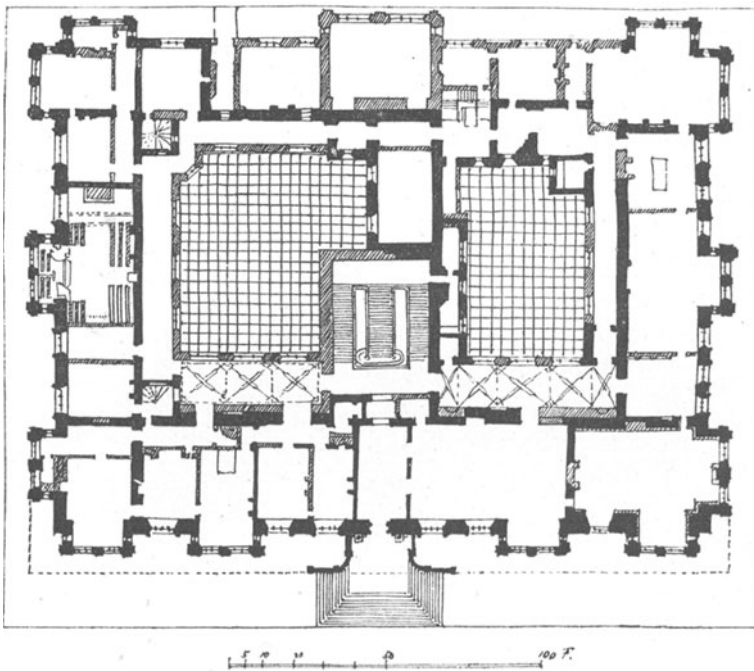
Longleat House. Grundriss. (n. Britton.)
